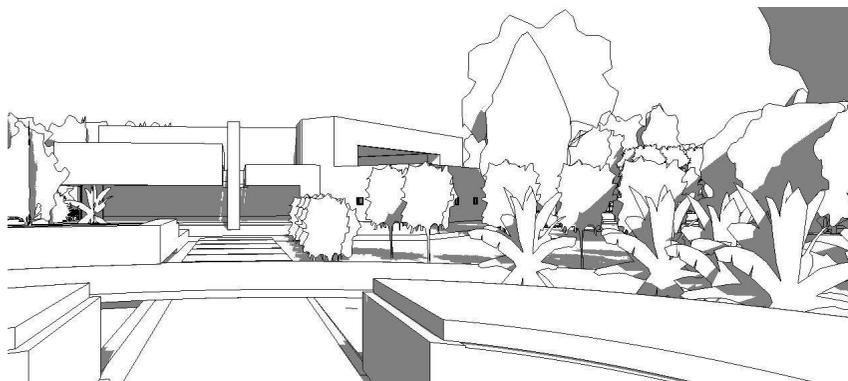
Acceso principal a la sala de exposiciones visto desde el punto central del conjunto
